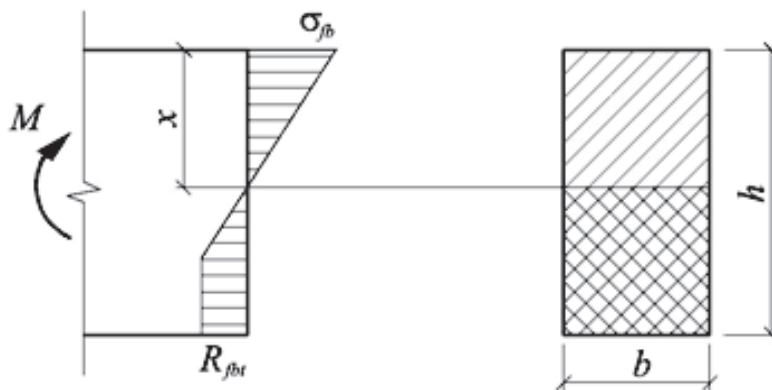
Схема усилий и эпюра напряжений в сечении, нормальном к продольной оси, при расчете по прочности изгибаемого сталефибробетонного элемента прямоугольного сечения без арматуры
